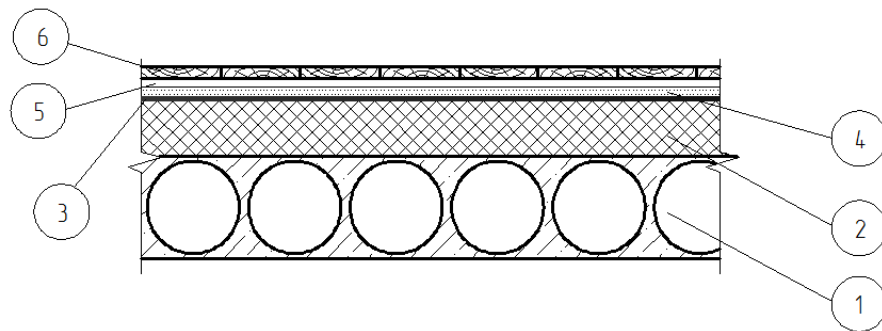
Схема до теплотехнічного розрахунку перекриття над підвалом:
